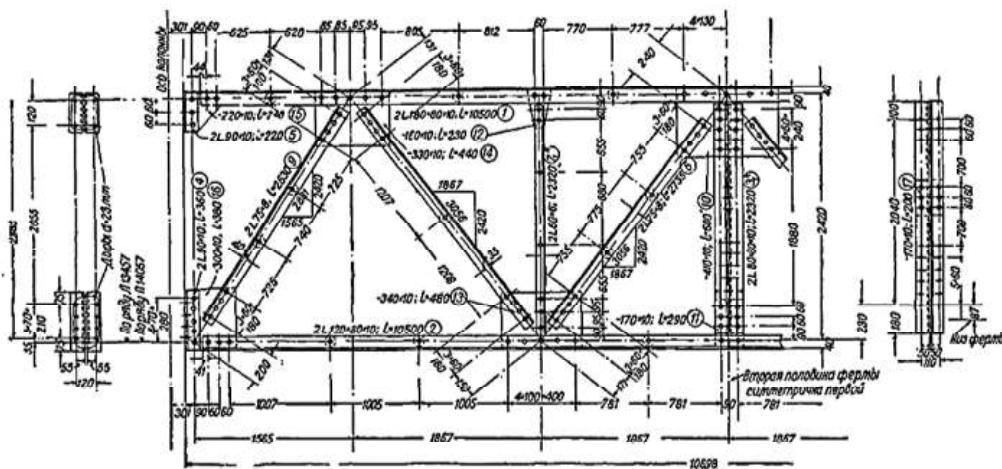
Рабочий чертеж подстропильной формы (марки) с различными масштабами для геометрической схемы и сборочных деталей [4].
